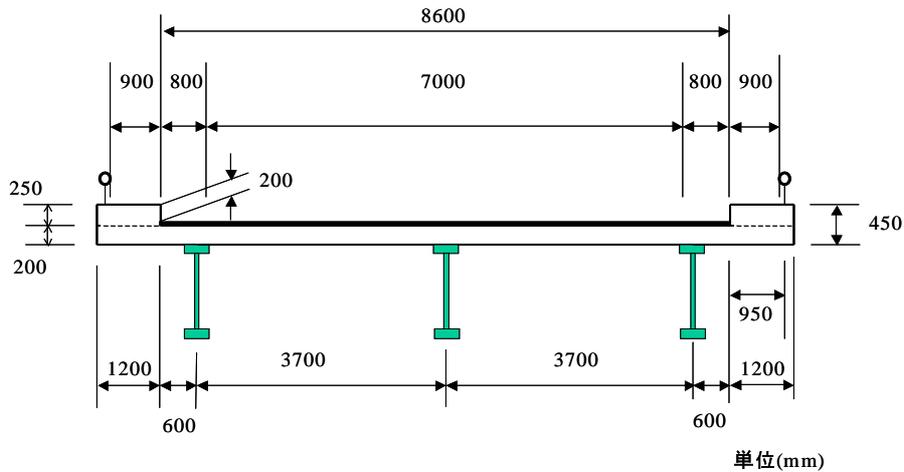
主桁間隔 370cm のプレートガーダー橋の断面図
